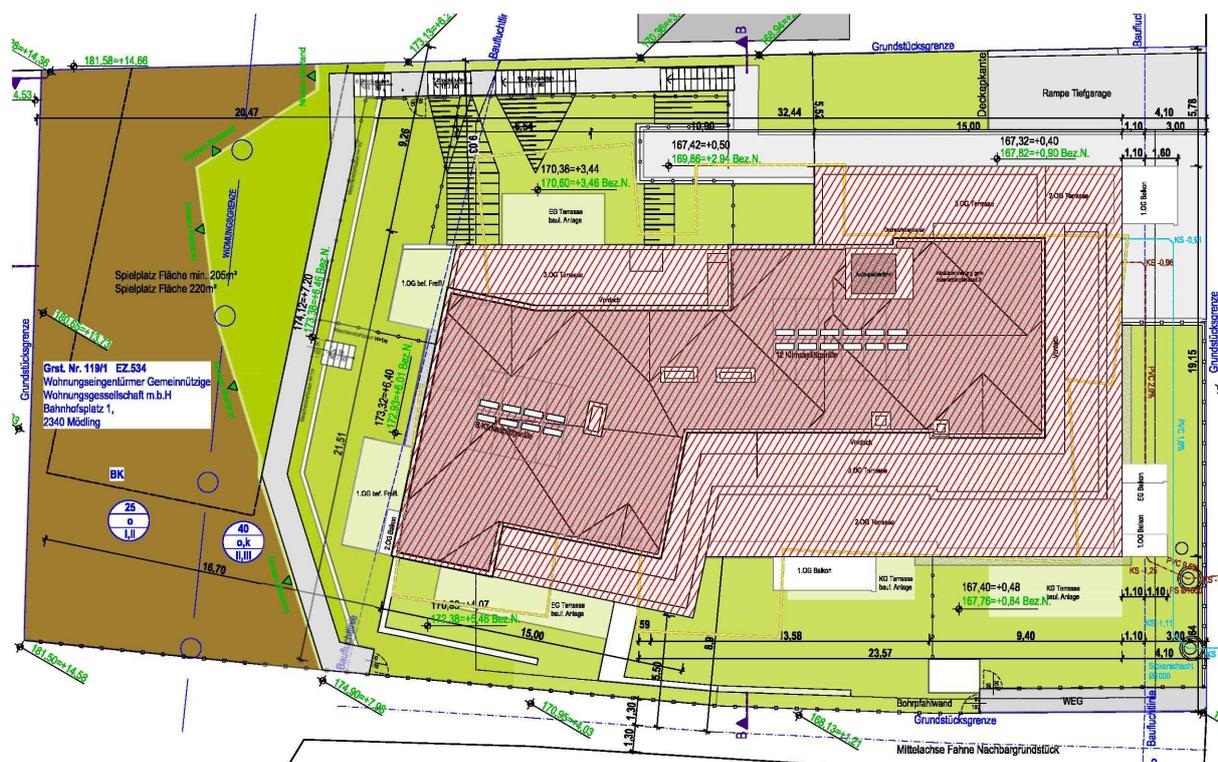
Lageplan des zu errichtenden Bauprojekts (Quelle: Kosaplaner GmbH)
